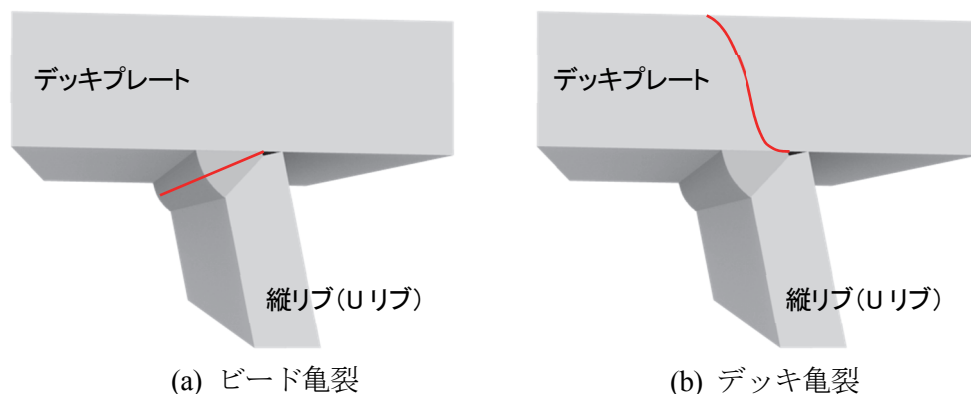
デッキプレート-縦リブ 溶接部の損傷タイプ(④)
